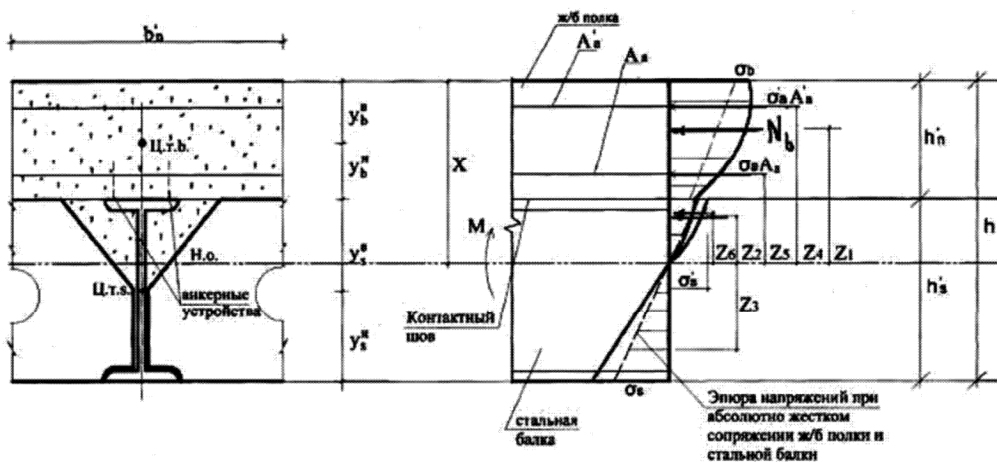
Схема усилий и напряжений в сталежелезобетонном сечении
